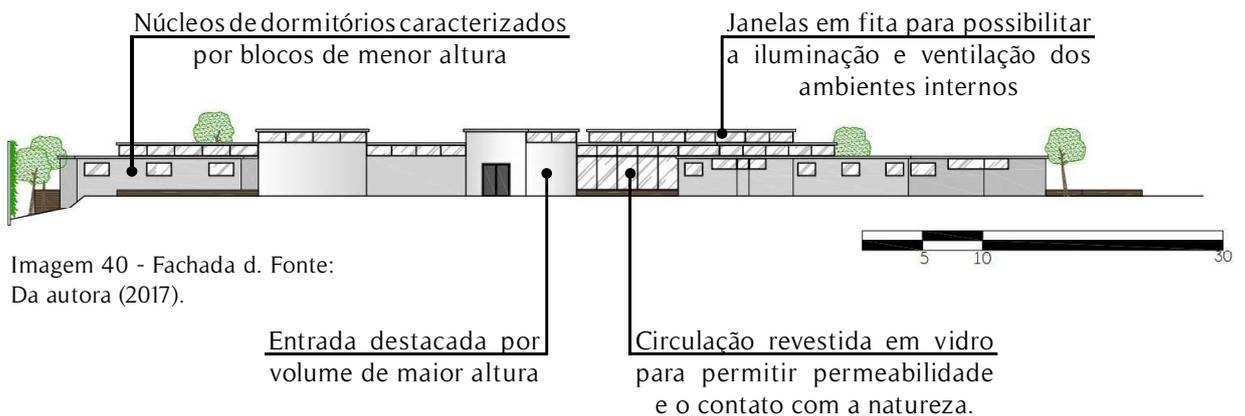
Fachada d. Fonte: Da autora (2017).
